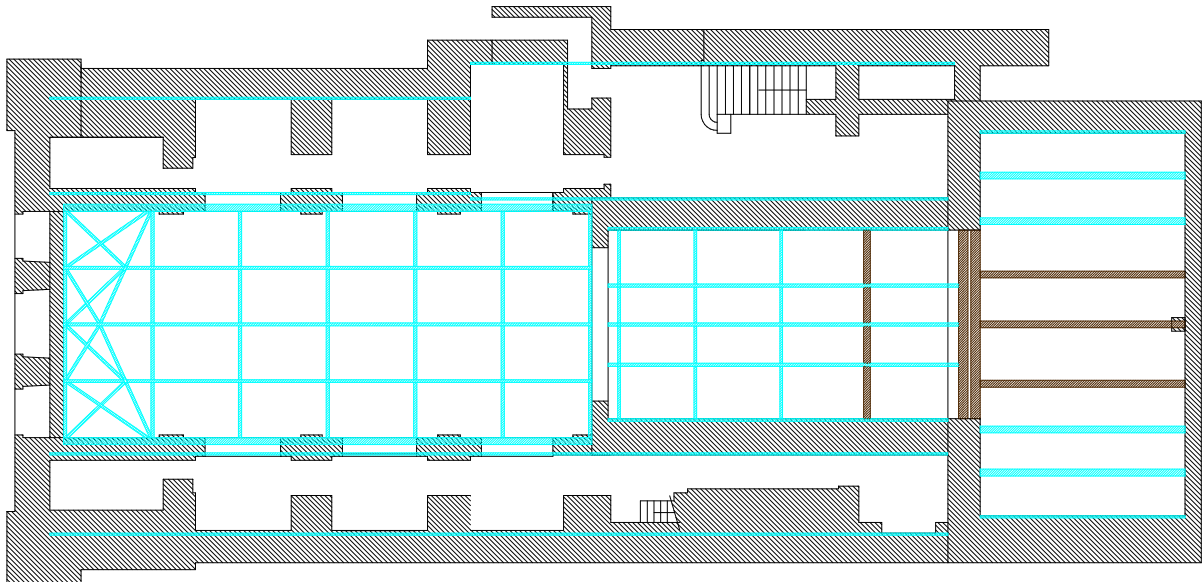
Planta estrutural de intervenção (sem escala).
